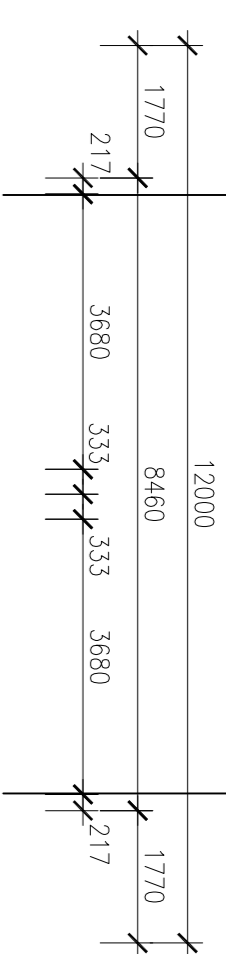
DETAIL SLOUPKU STŘEŠNÍHO PĚŠTĚ
